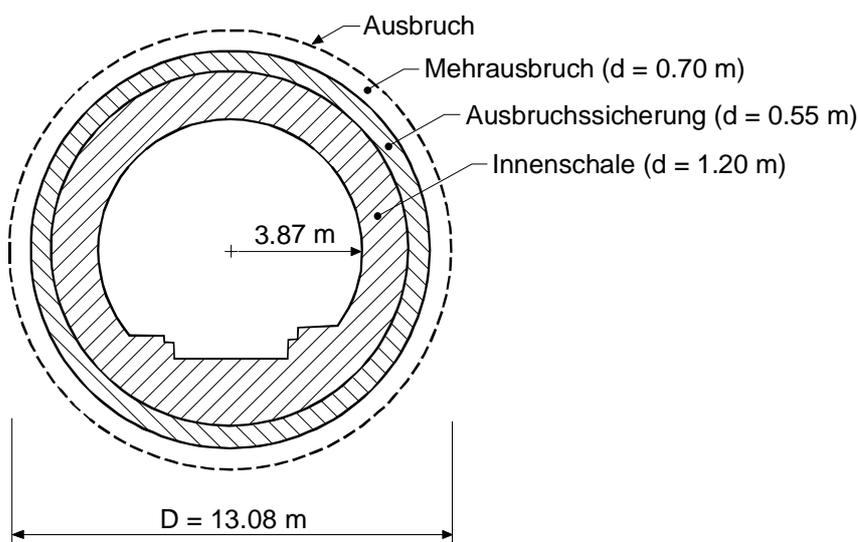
Schematische Darstellung des Tunnelprofils mit Mehrausbruch und Ausbaustärken nach gänzlichem Ausschöpfen der eingeplanten Konvergenz
